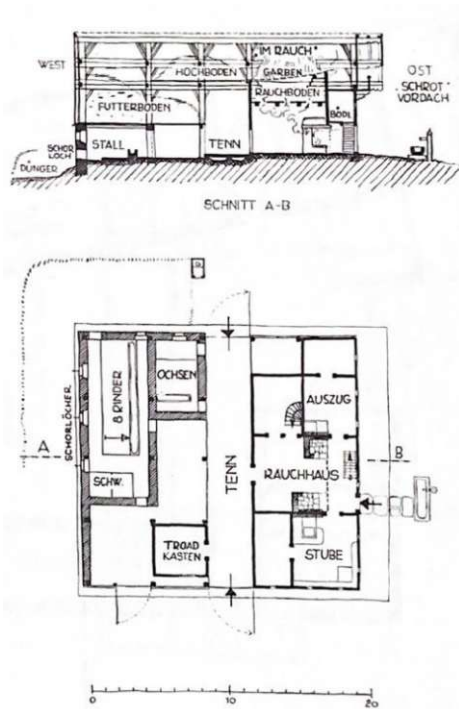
| Grundriss und Schnitt. Einhaus "Spiegelstedt". Zell am Moos.
